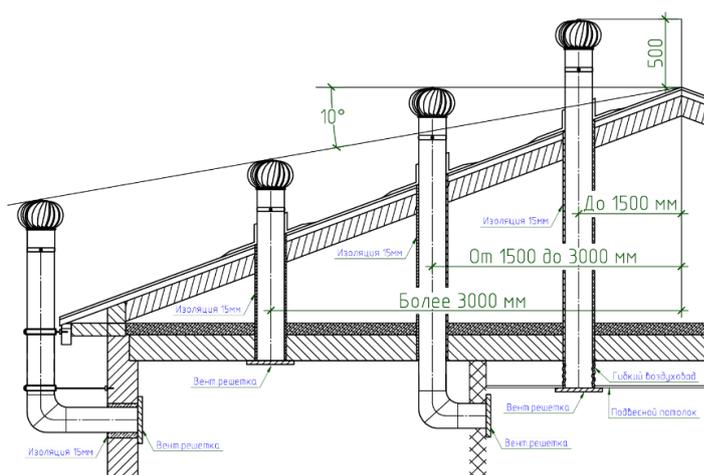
Схема установки ротационных дефлекторов на вентиляционные трубы круглого сечения.
